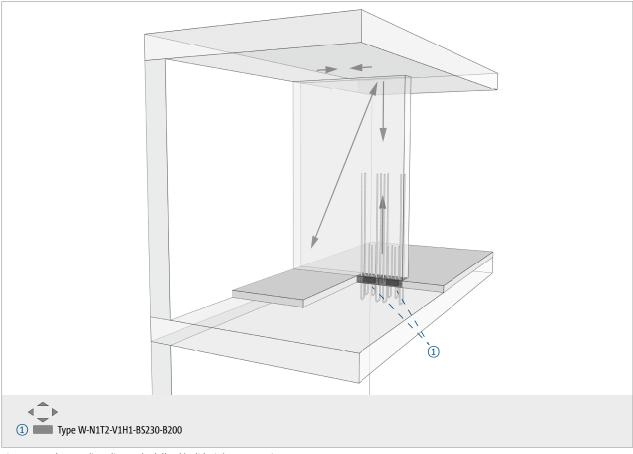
Mur de cage d'escalier sur la dalle, désolidarisé, sans appui
